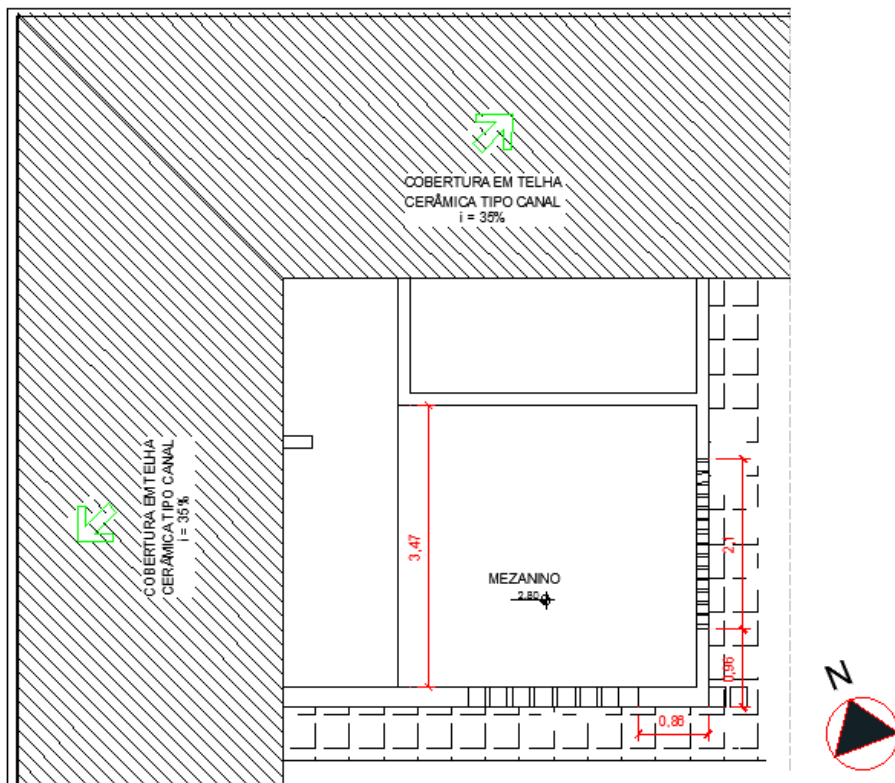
Planta baixa do pavimento superior-mezanino da Eco Residência
